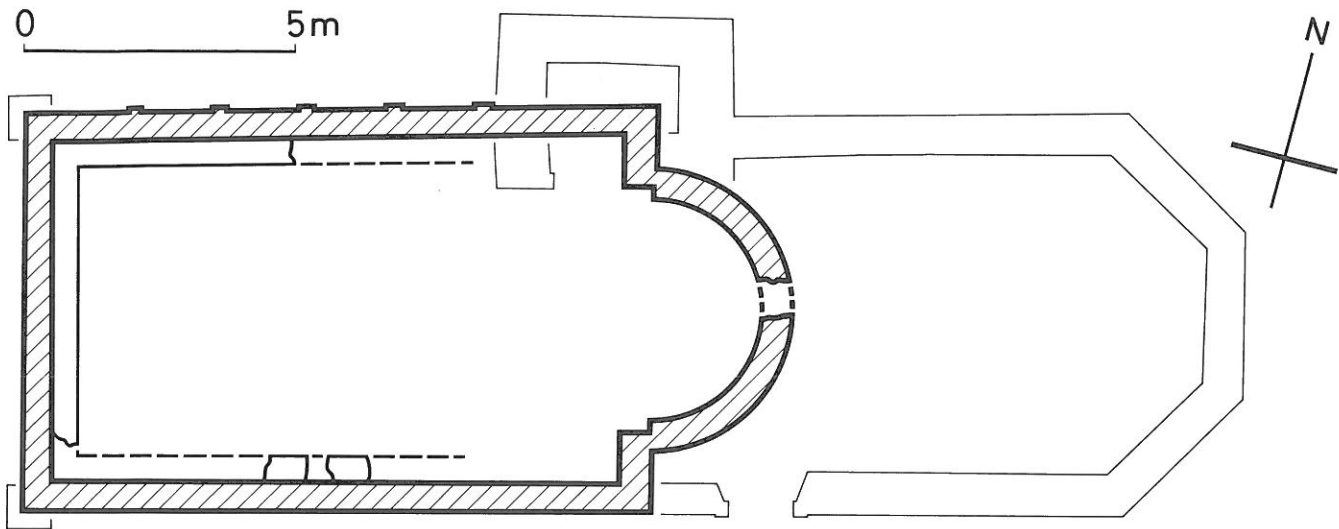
Rekonstruierter Grundriss der Anlage III. M. 1:140
